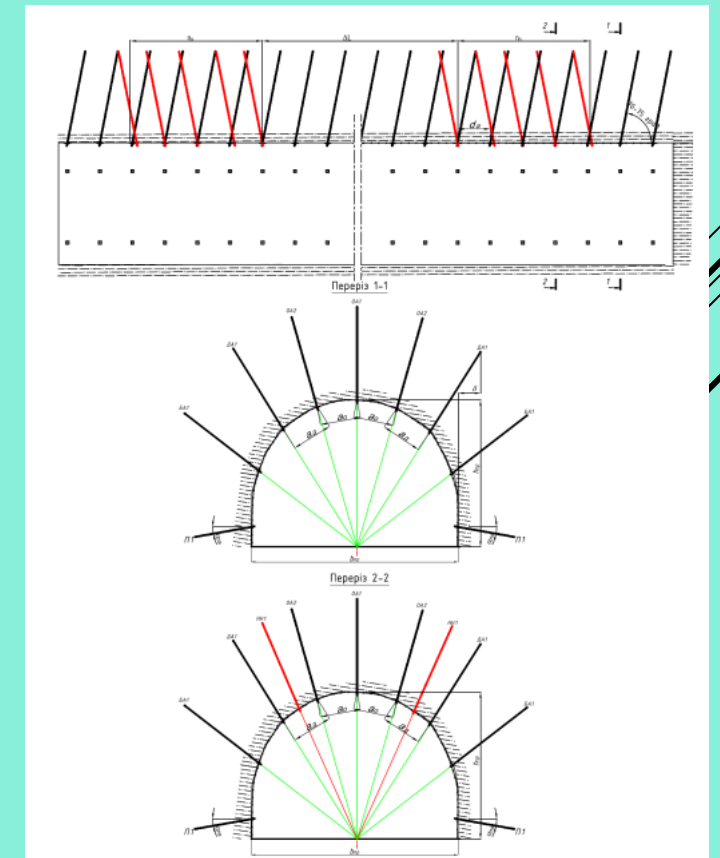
Схема розміщення анкерів для формування конструкцій АК для гірничих виробок аркового поперечного перерізу
